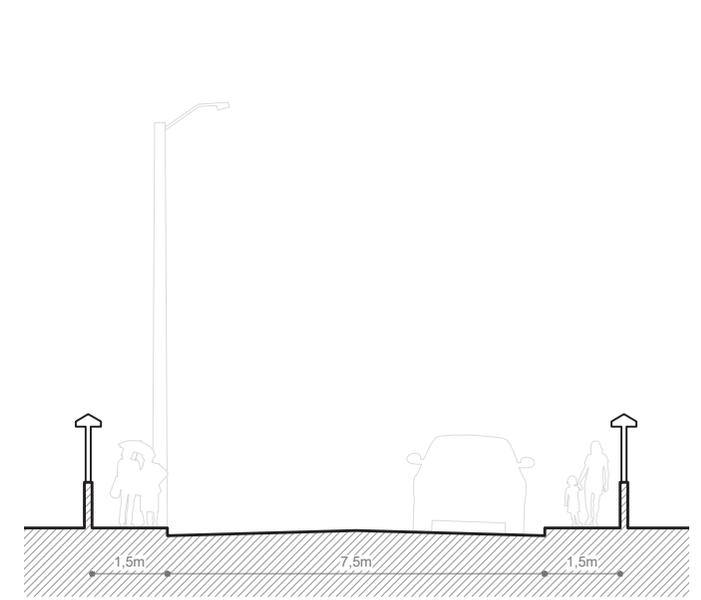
Sección 03 Calle Alfonso Cabrera
